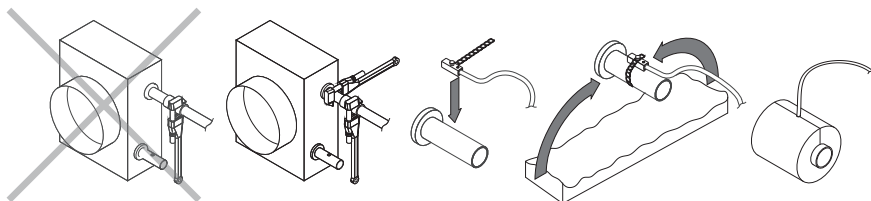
Raccordement des flexibles du dispositif de chauffage/refroidissement à eau et installation d'un capteur de température d'eau
